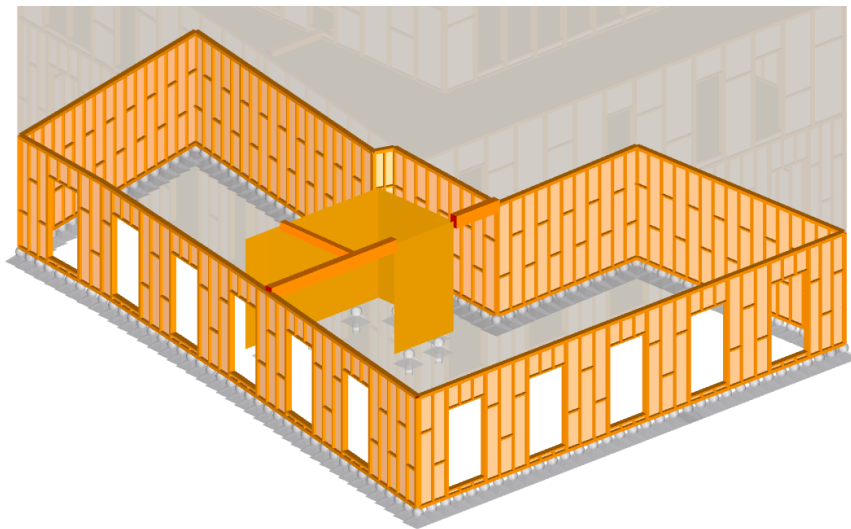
Esquema estrutural para apoio dos painéis CLT de piso
